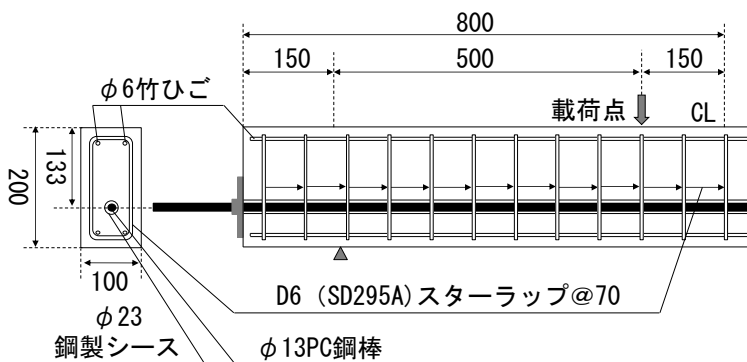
載荷試験用供試体の形状・寸法 (単位: mm)
